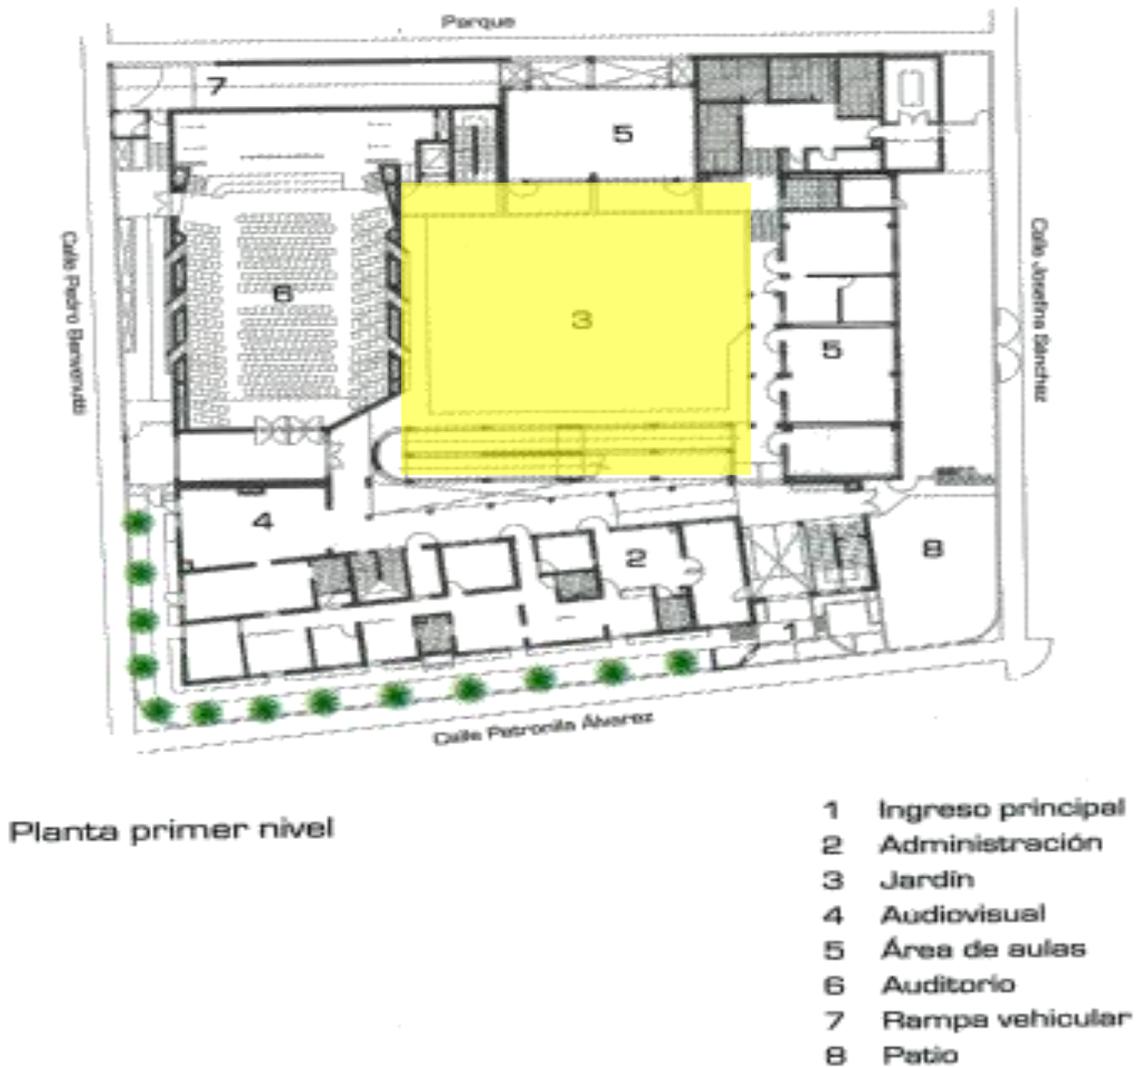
Planta del primer nivel, fuente: José Bentín Arquitectos
